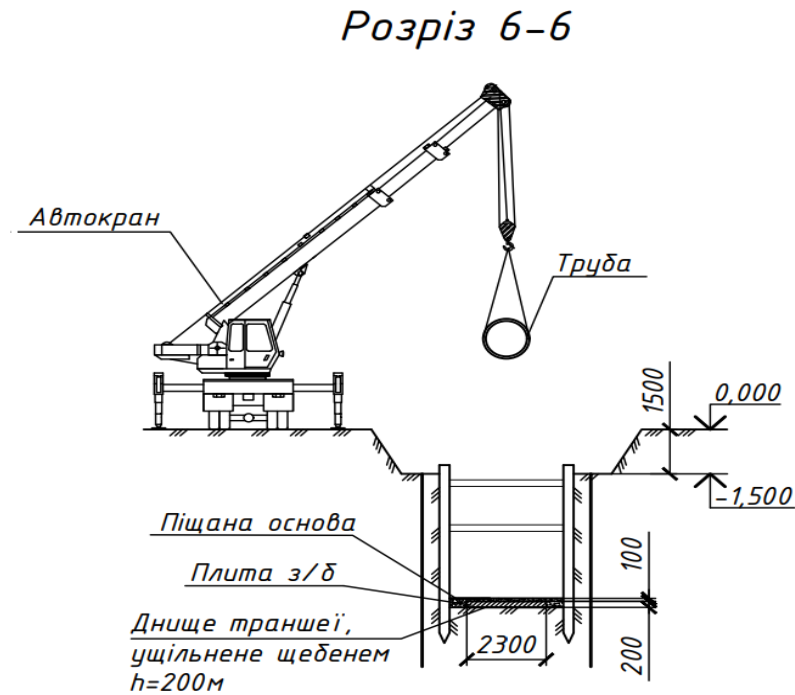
Схема монтажу труби. Розріз 6-6.
